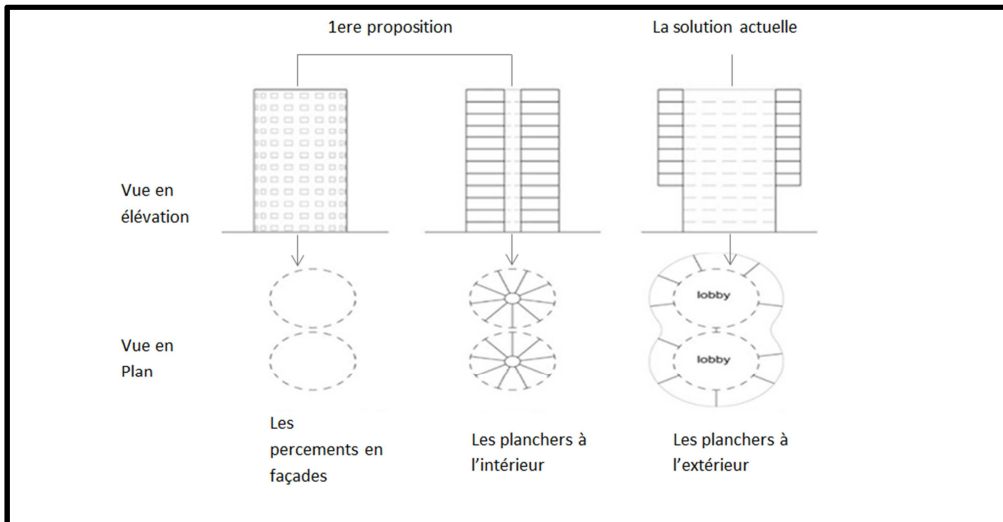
Schéma représentant les percements possibles dans la structure et le concept du projet, un " Inside out" ou reversement vers l'extérieur n source : Etude d'une pensée constructive d'architecte, Gemini résidence.
